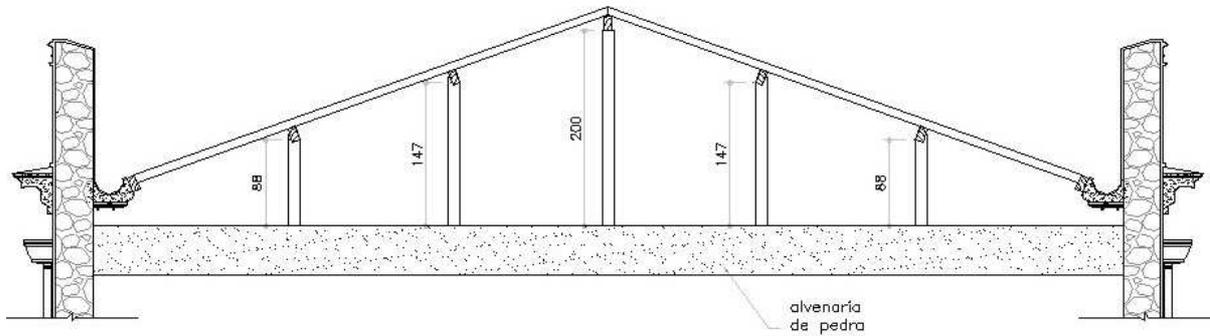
Estrutura com pontaletes do Palácio Universitário.
